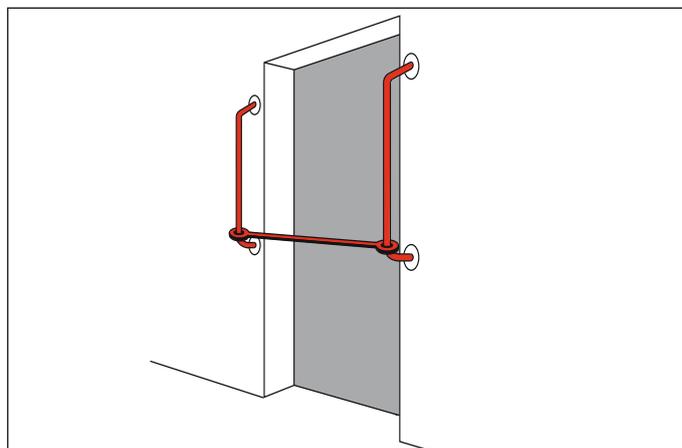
l'apertura nella parete è protetta da una barra sollevabile. Attenzione: una volta sollevata, la barra non può restare bloccata in alto, ma torna automaticamente alla posizione di partenza.
